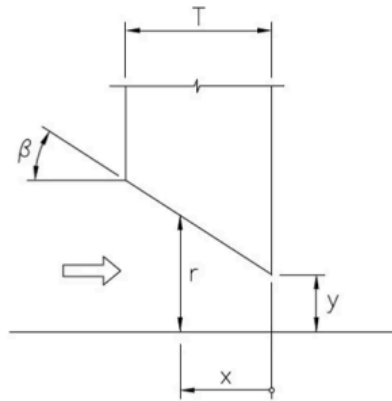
Vista de perfil de la compuerta. ORIGEN: Design of Hydraulic Gates, Paulo C.F. Erbisiti.
